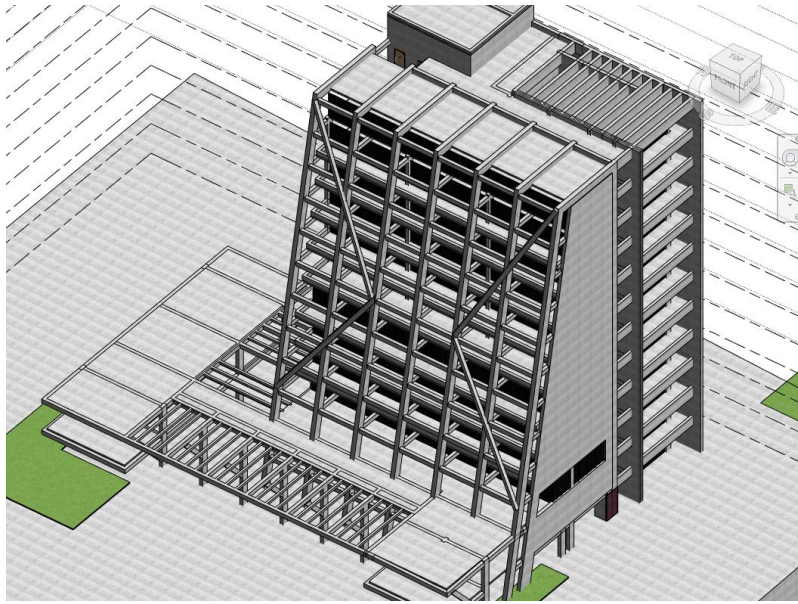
Propuesta estructural centro cultural y residencia temporaria para la integración del ciudadano extranjero.
